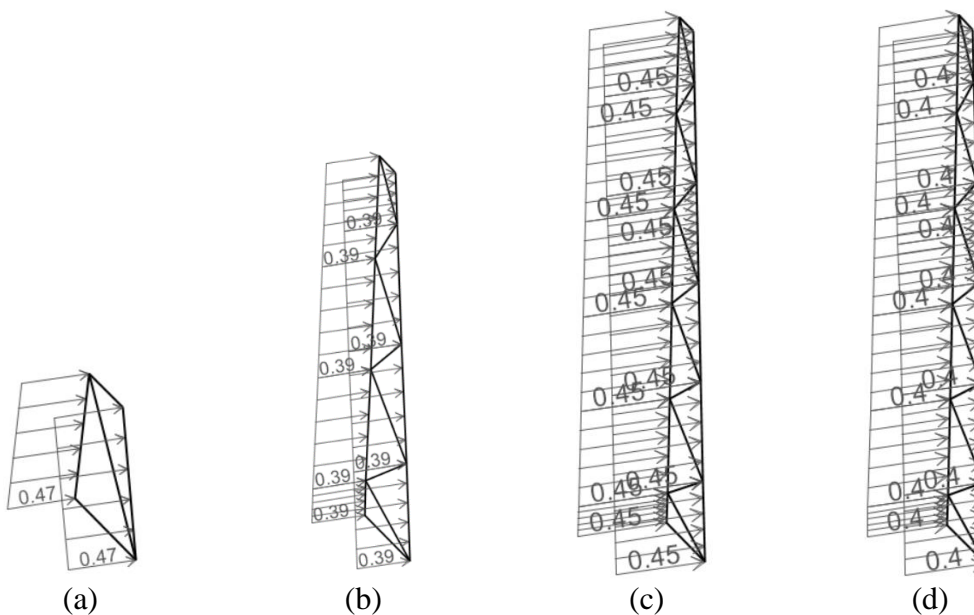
Vento W_x : (a) Pilar P1; (b) Pilar P2; (c) Pilar P3, P4 e P5; (d) Pilar P6
